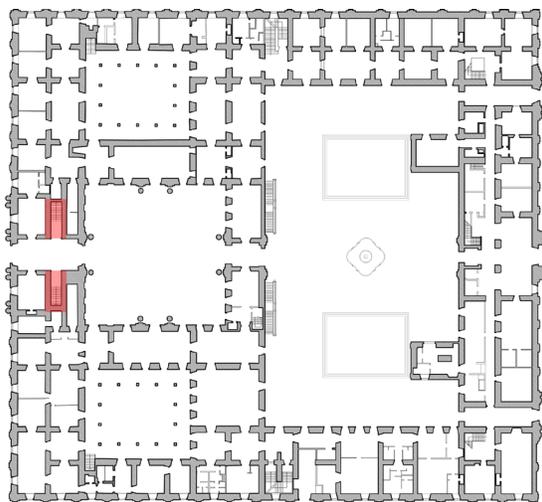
Bóvedas en planta actual primer nivel Palacio de La Moneda. Elaboración propia
